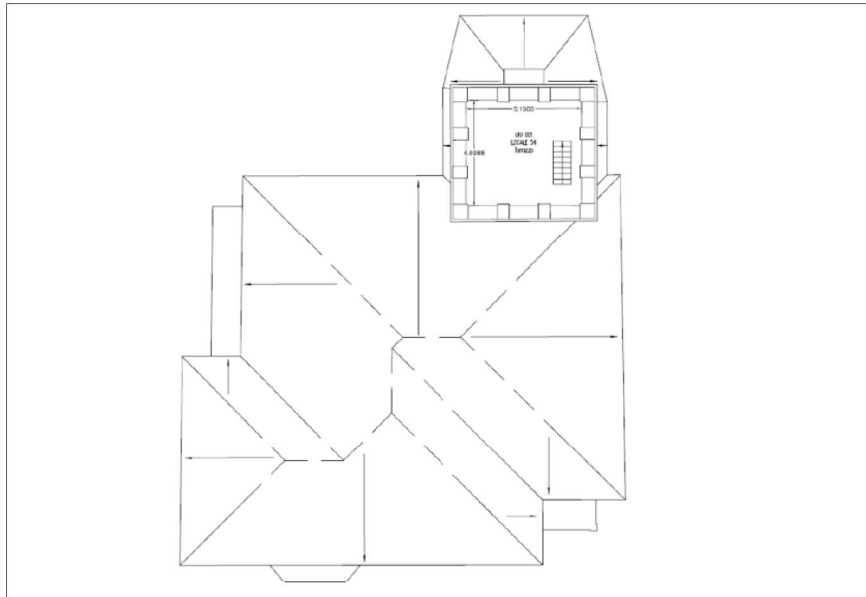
Planimetria Copertura - Palazzina Liberty di Villa Gruber
